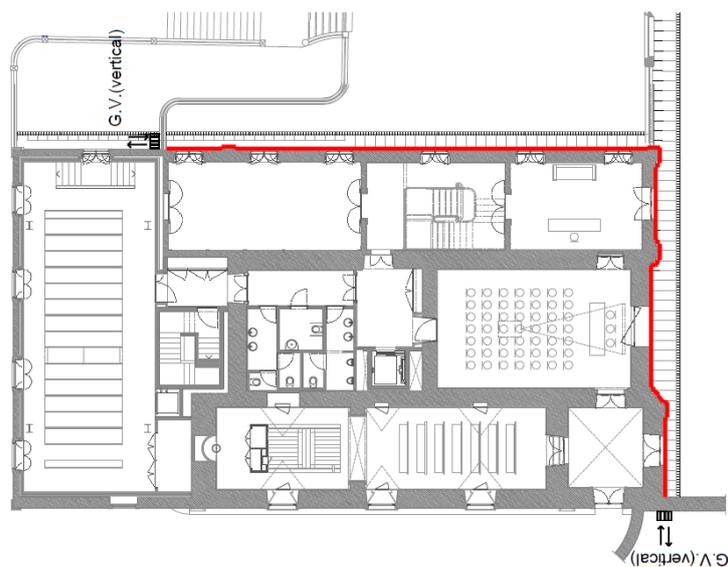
Esquema da configuração do sistema de ventilação da base das paredes a implementar nas fachadas norte e este do edifício.
